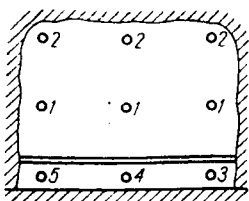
Схема расположения шпуров и порядок отбойки угля гидроотбойными патронами.
